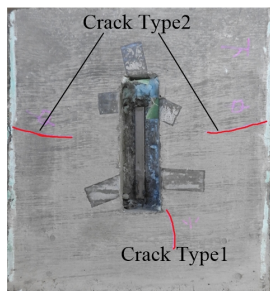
試験体 D45P28L-2 ひび割れ状況
